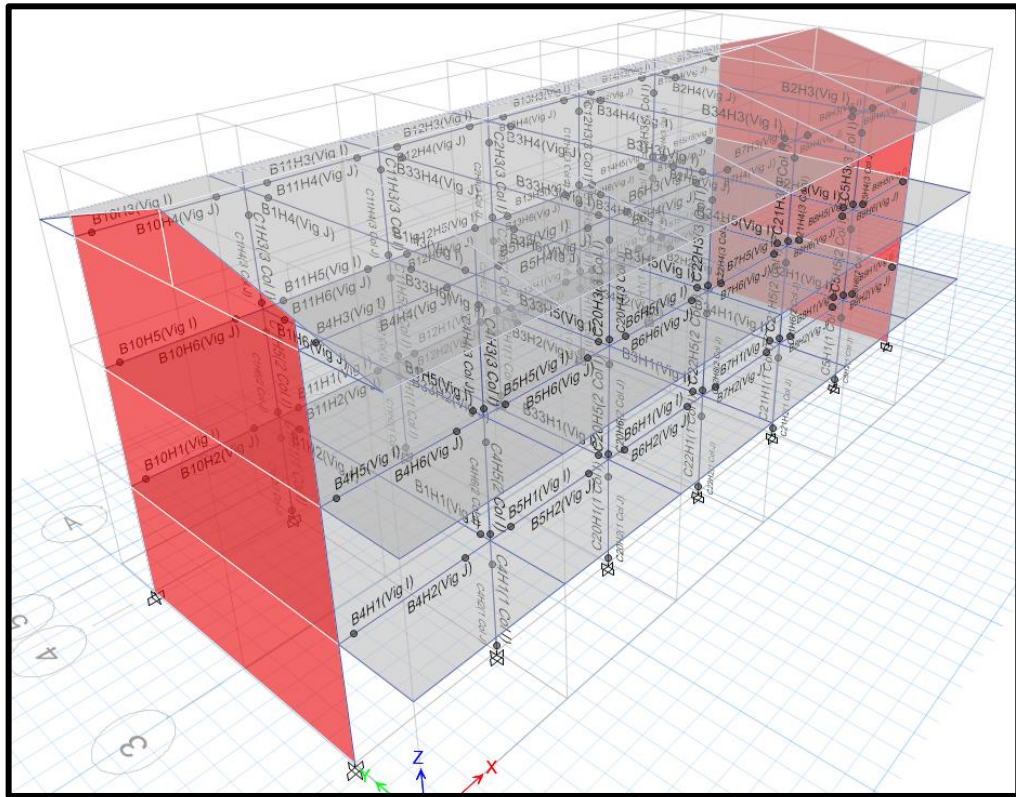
Vista General 3D con las Rotulas Plásticas asignadas en Elementos Estructurales Vigas y Columnas.
